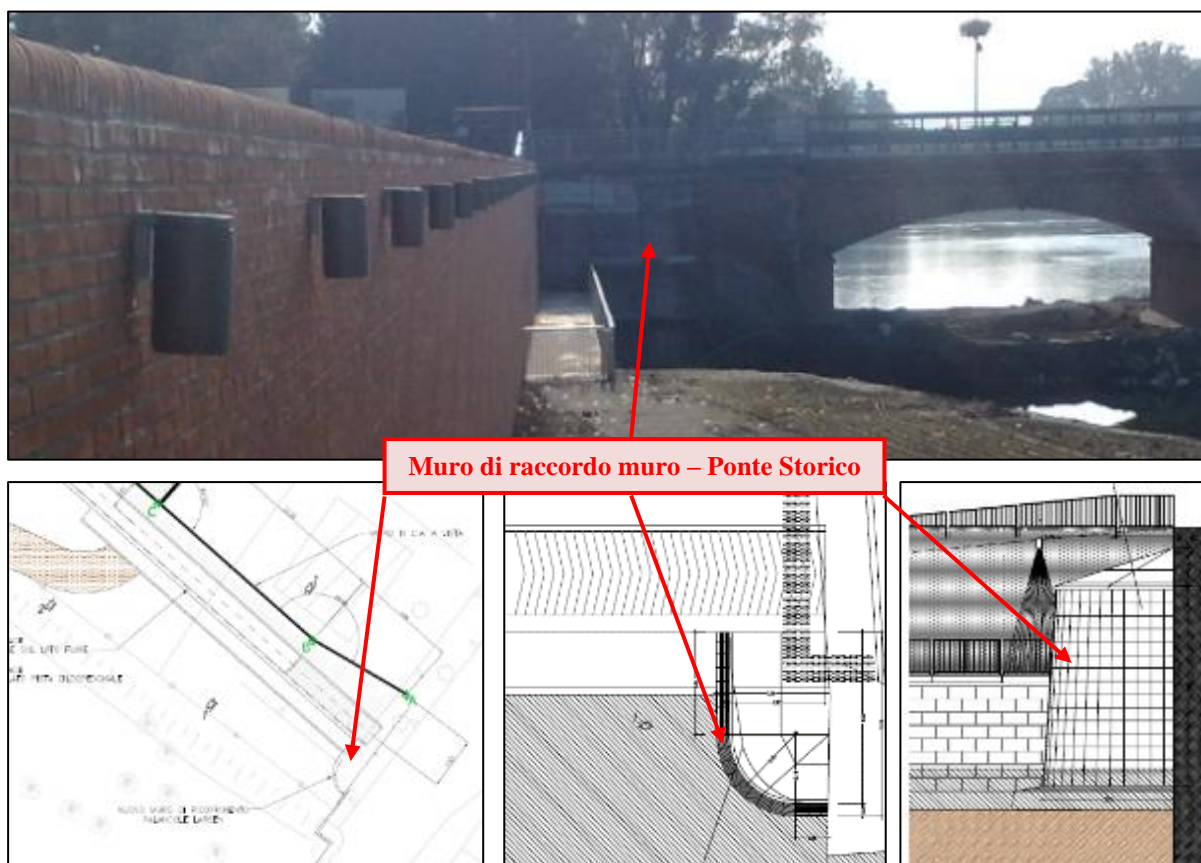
Situazione attuale muro di raccordo nuovo muro – Ponte Storico
